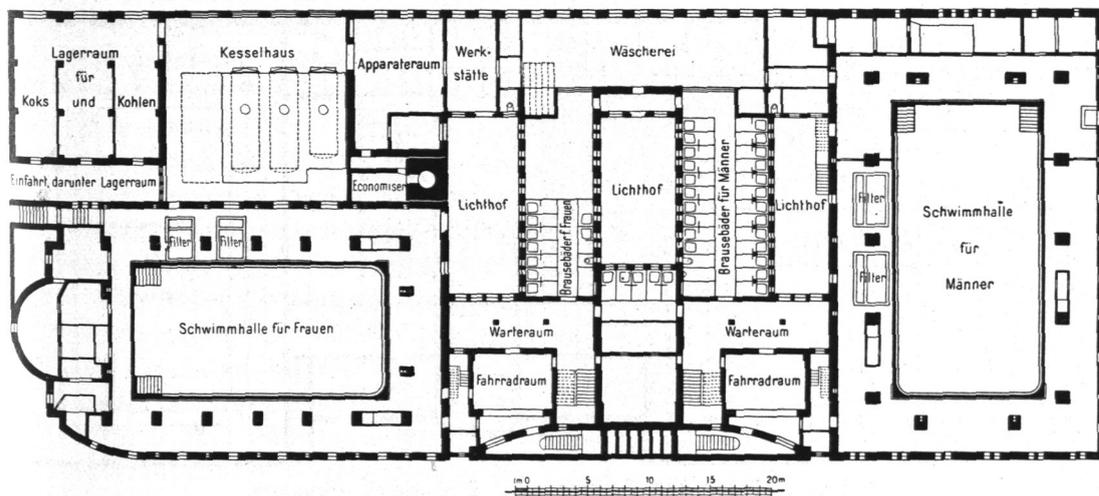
Badeanstalt Hammerbrook, Kellergeschoß, Grundriß.
